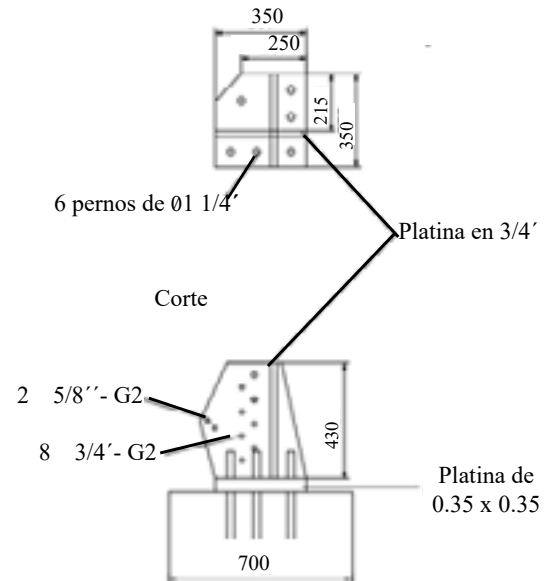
Corte transversal de cimentación. Autoría propia.
